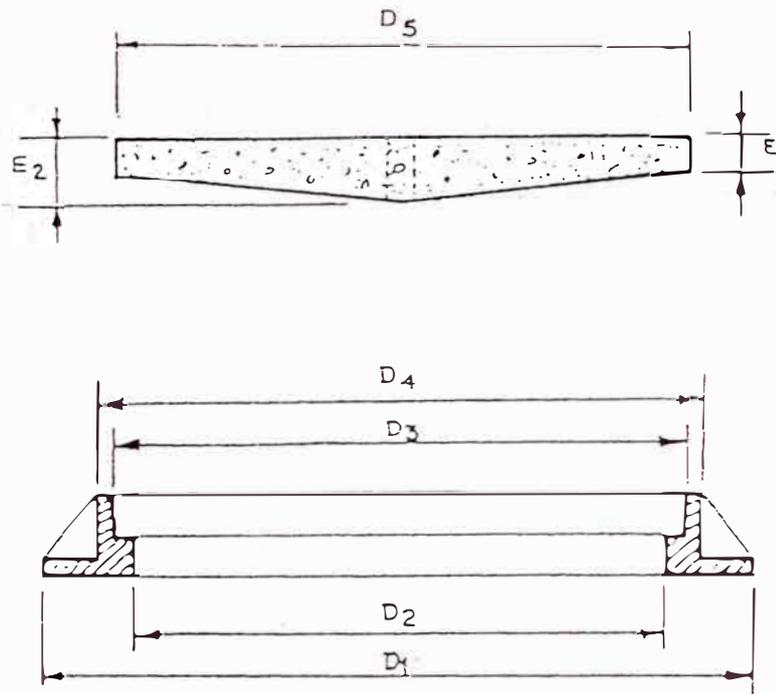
Diagrama esquemático del marco de hierro fundido y la tapa de hormigón armado
